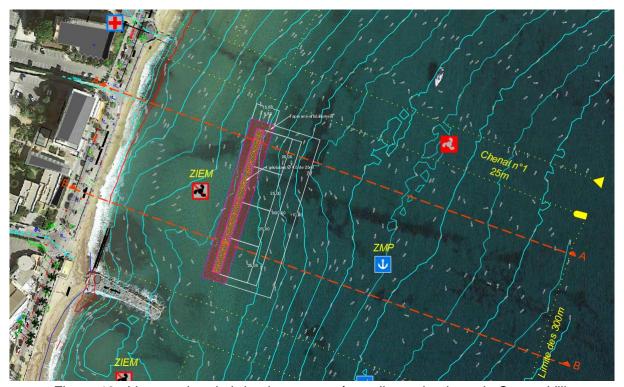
Vue en plan du brise-lames en géotextile sur la plage du Centre-Ville
